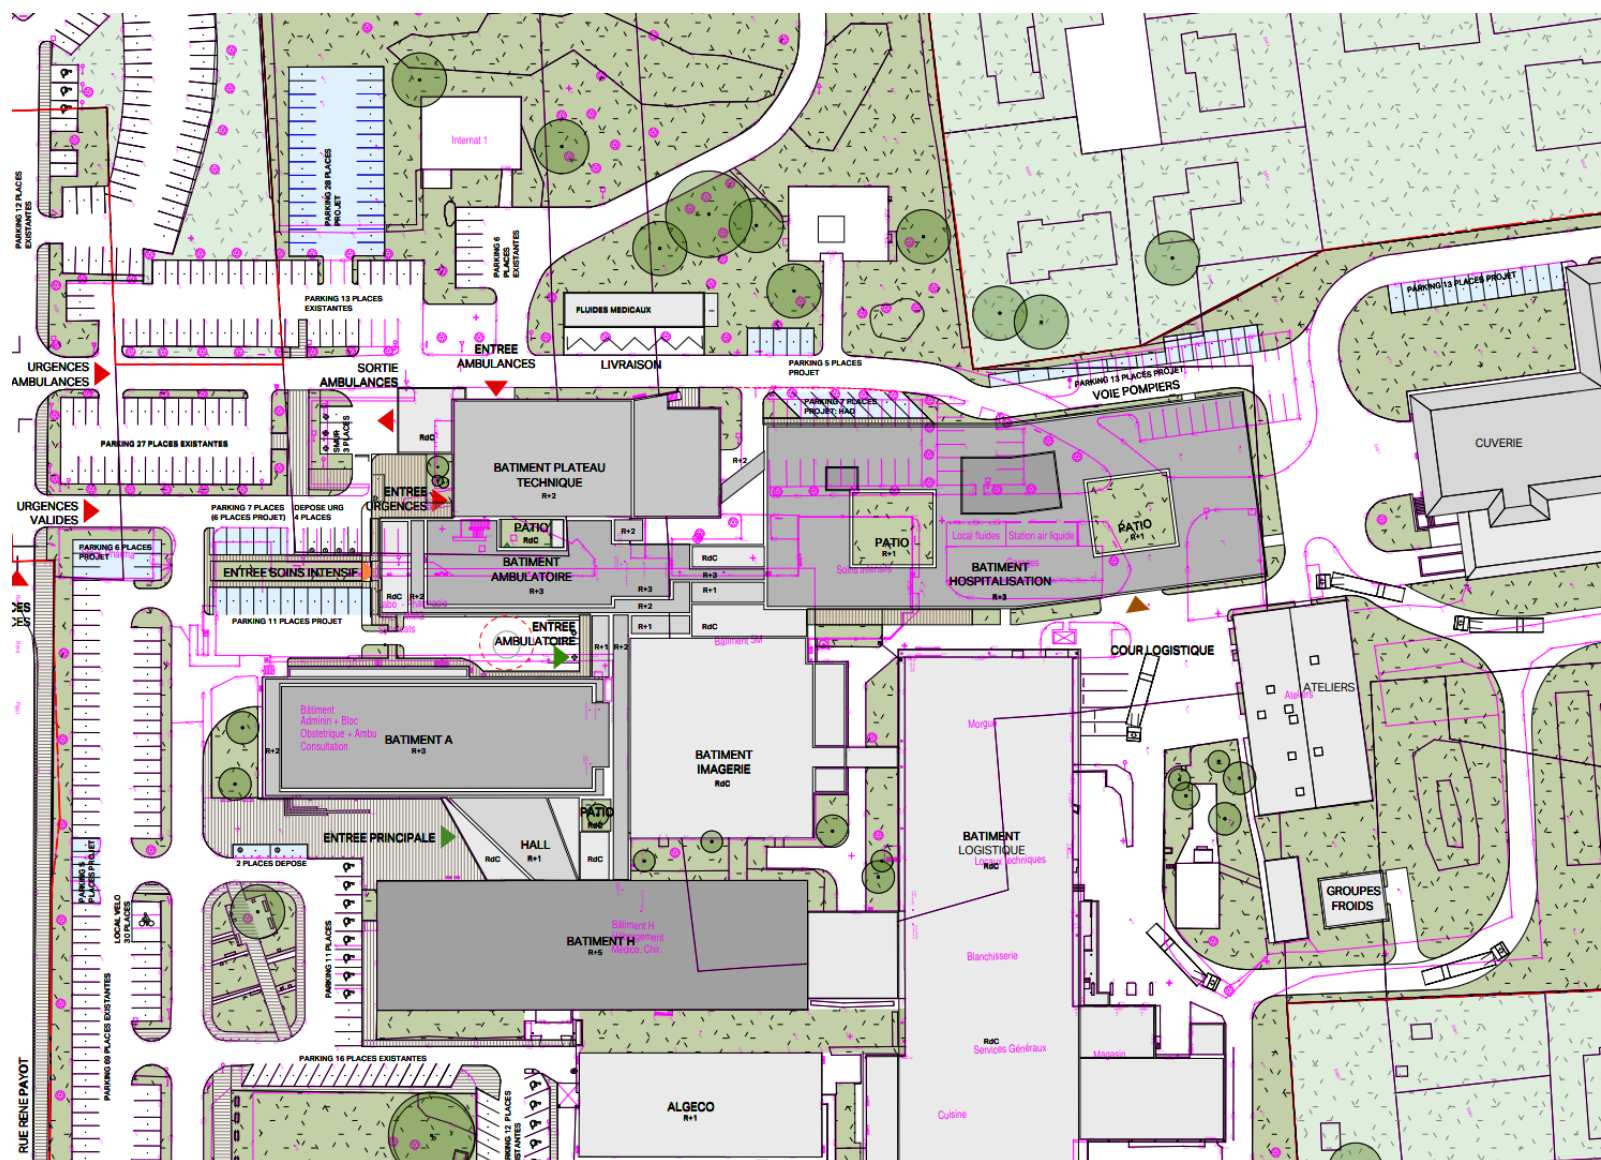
Plan projet avec fond existant (en rose) (Source : ARCHITECTURESTUDIO 2023)
